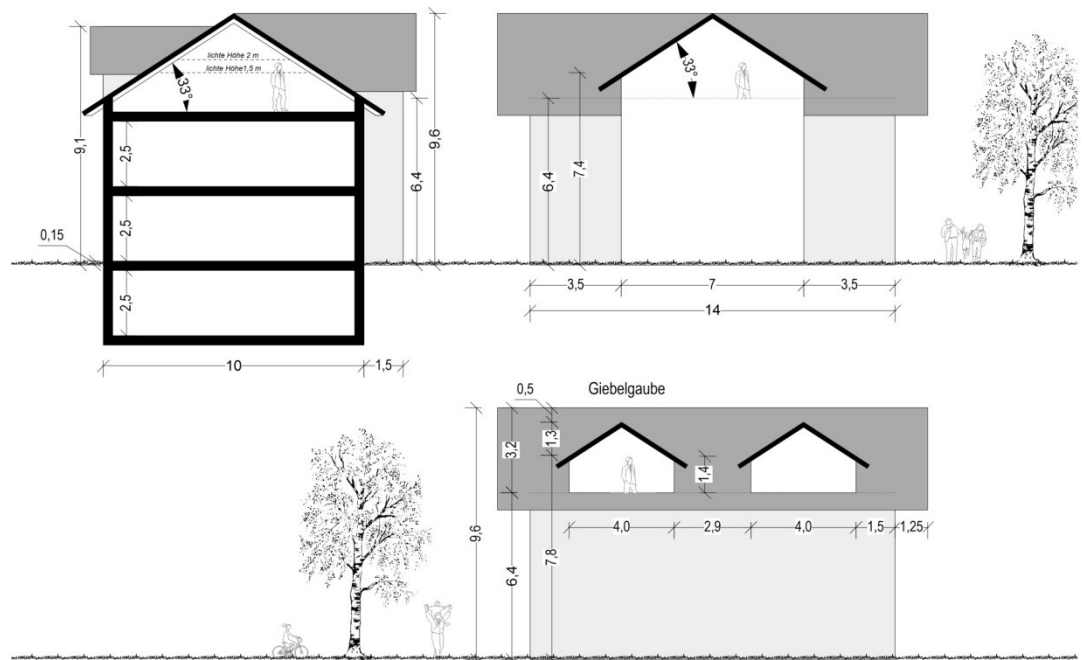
Schnitt und Schemaansichten mit Dachaufbauten (Quergiebel und Gauben) bei einer Dachneigung von 33°, ohne Maßstab
